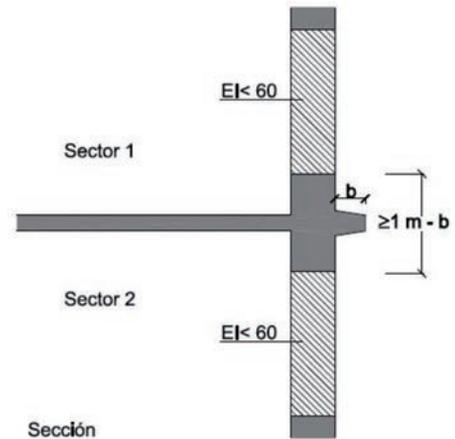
Detalle constructivo de la resistencia al fuego exigida en encuentro de forjado-fachada, con existencia de voladizo.
